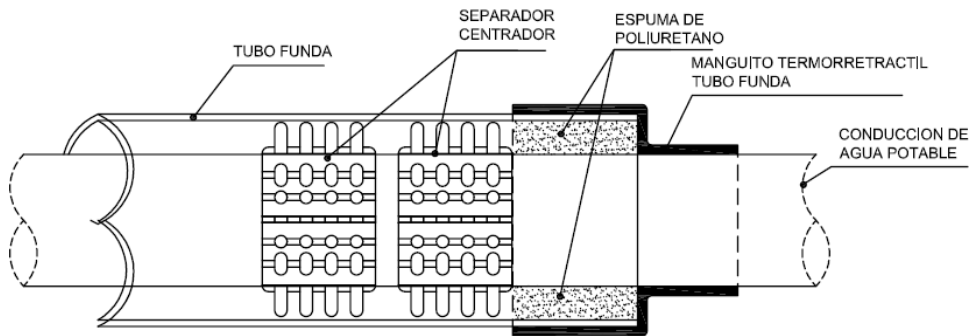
Imagen detalle de vaina en hincas y elementos aislamiento.
